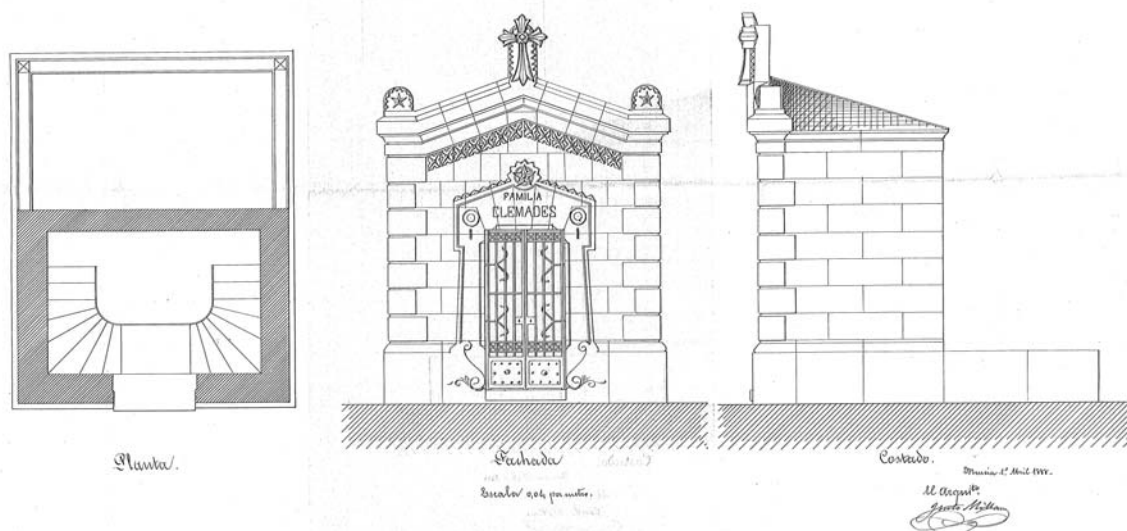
Planta, fachada y alzado del panteón de la familia Clemades. Justo Millán
